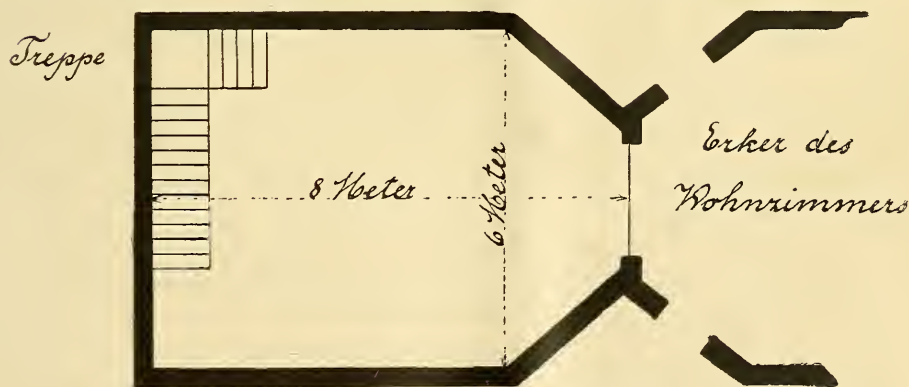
Grundriss des Wintergartens des Herrn Carl Lackner in Steglitz bei Berlin.
